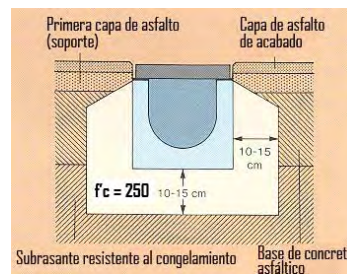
ÁREAS PAVIMENTADAS CON CARPETA DE ASFALTO
